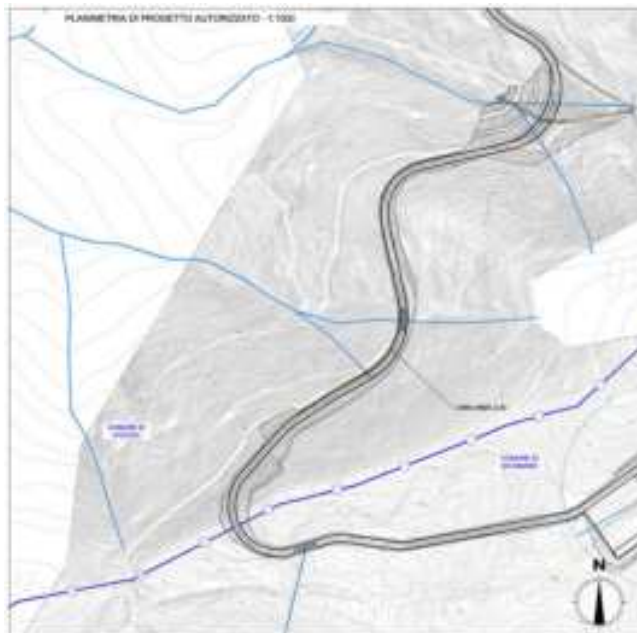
Progetto PAUR – Modifica della viabilità di sito
